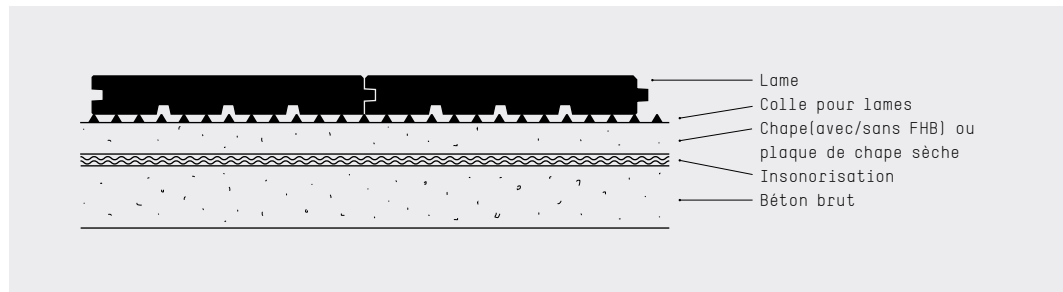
collage sur toute la surface de la chape ou chape sèche
